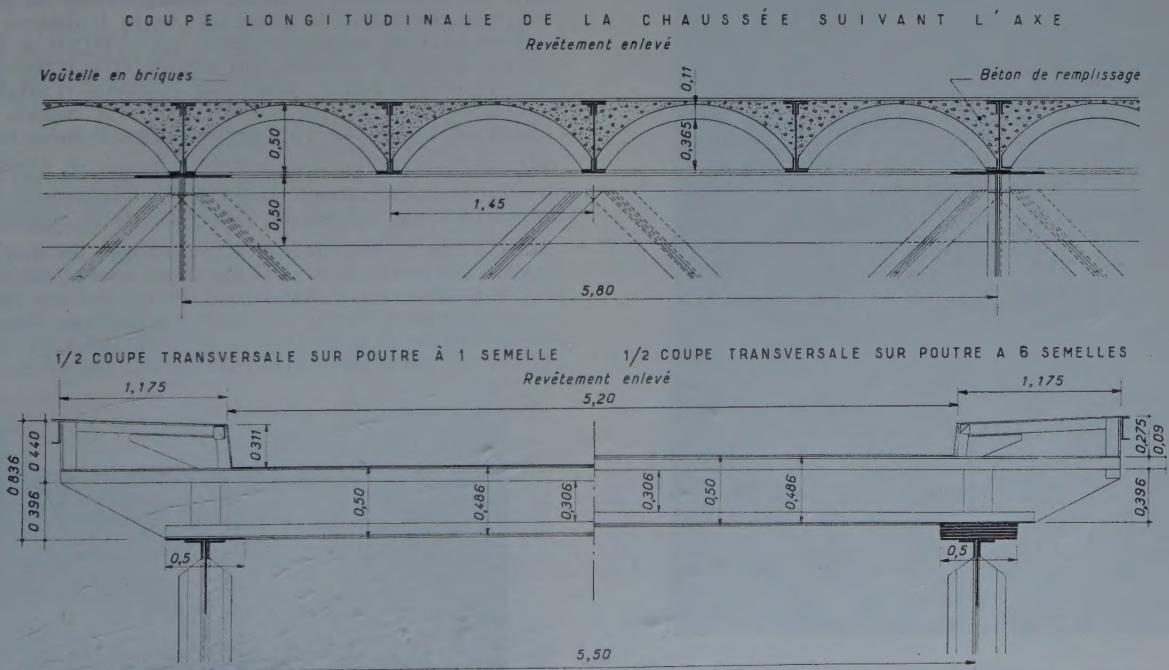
Coupe longitudinale et transversale au niveau des pièces de pont.
